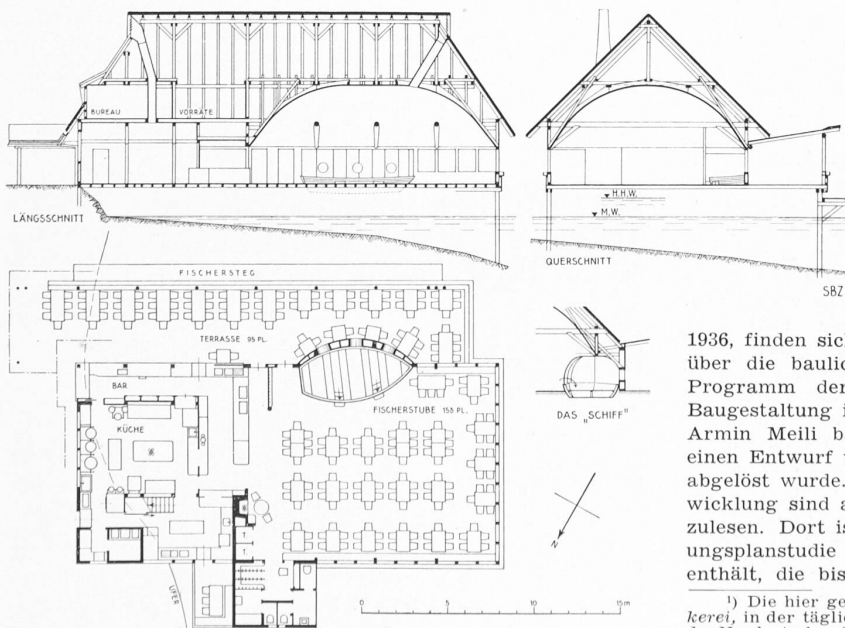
Grundriss und Schnitte der Fischerstube. — 1 : 400
